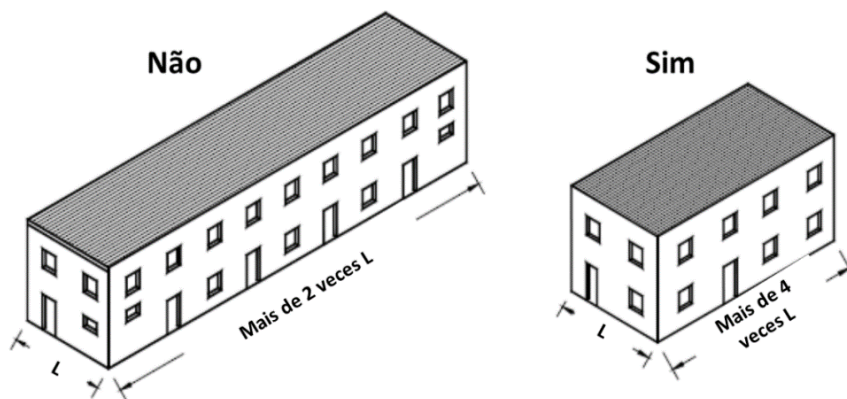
Esbelteza em planta (Meli e Brzev (2011)).
